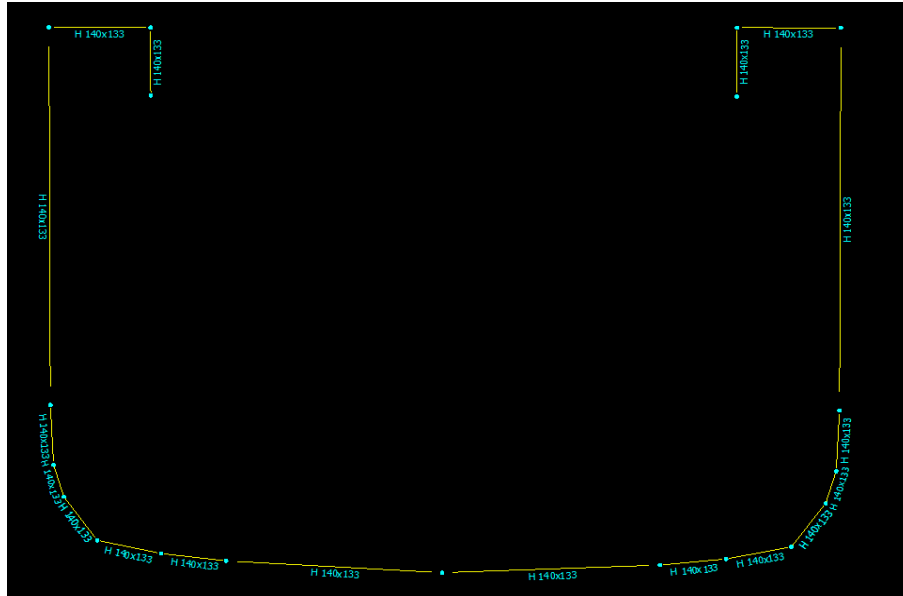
Reforzamiento transversal de la parte exterior de la estructura de protección.
